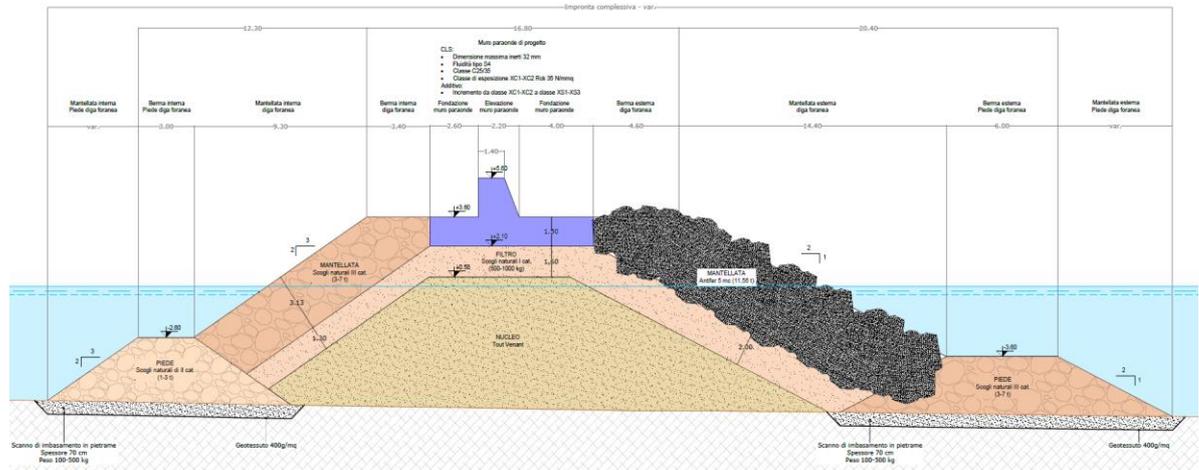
Sezione tipo della diga foranea di Sopraflutto
